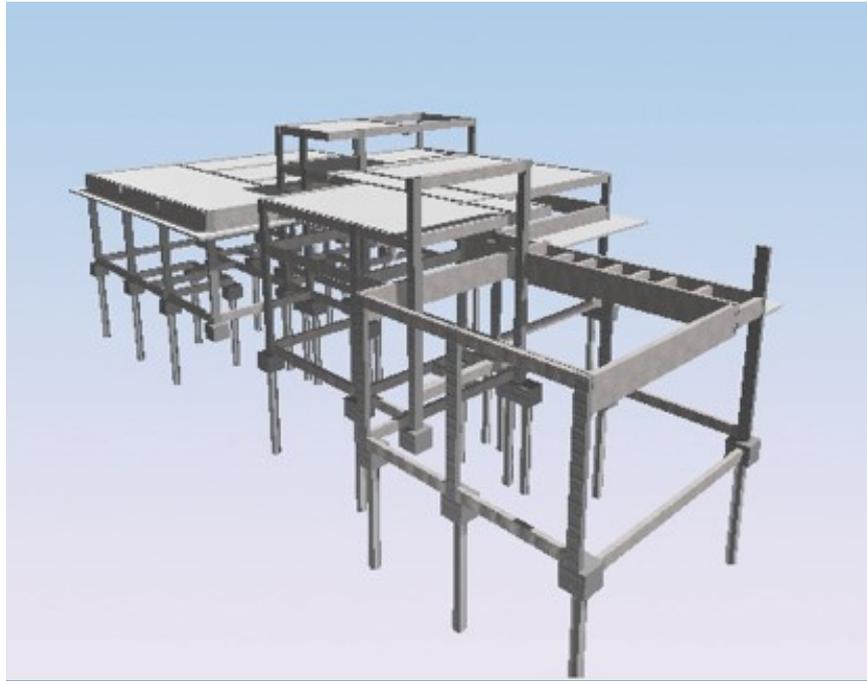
Lançamento dos elementos estruturais (Fonte: Autor, 2022)
